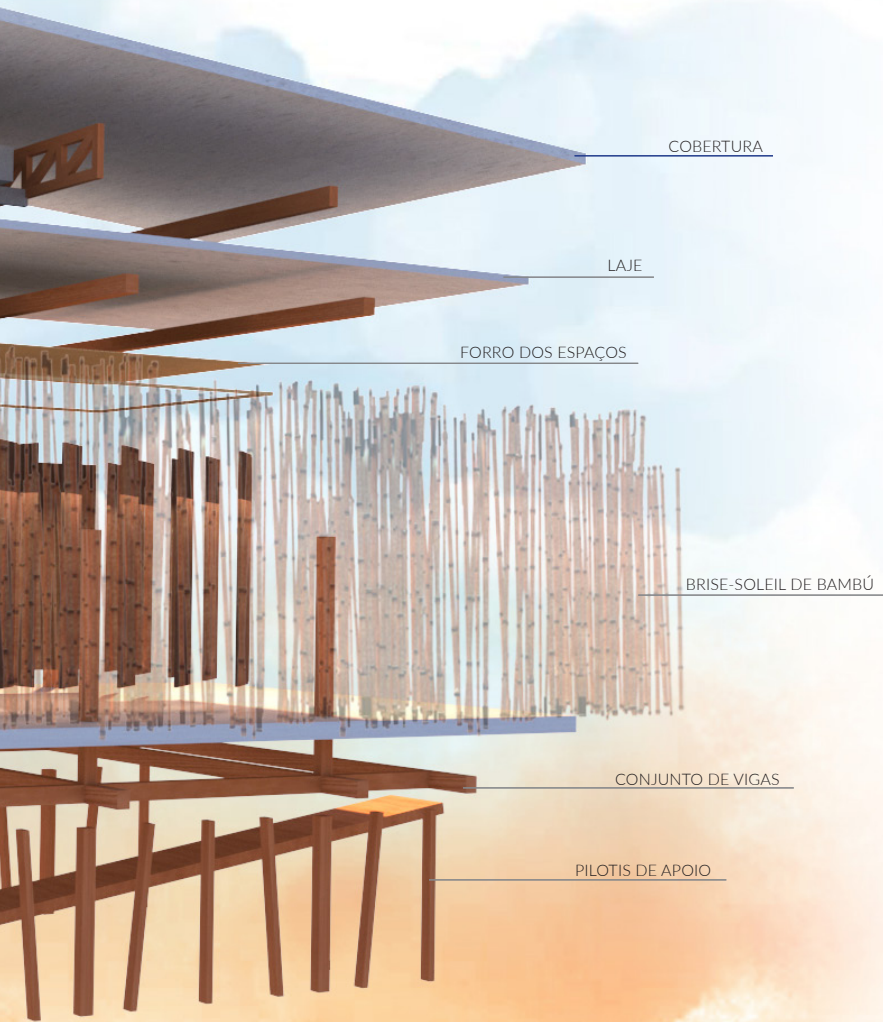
Esquema da estruturação do Projeto “Escola da Liberdade”
